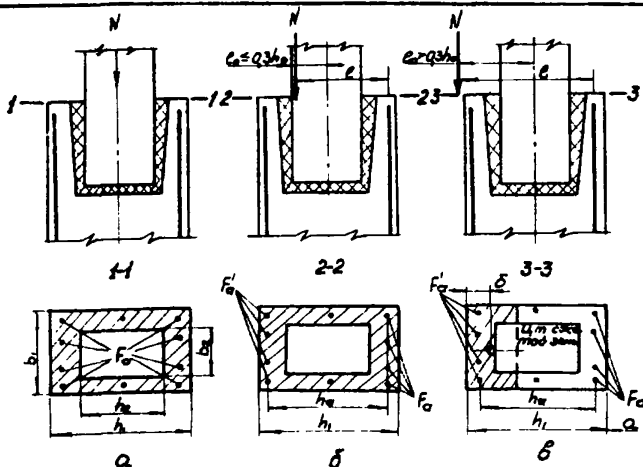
Схемы к расчету продольной арматуры стенок стакана:
